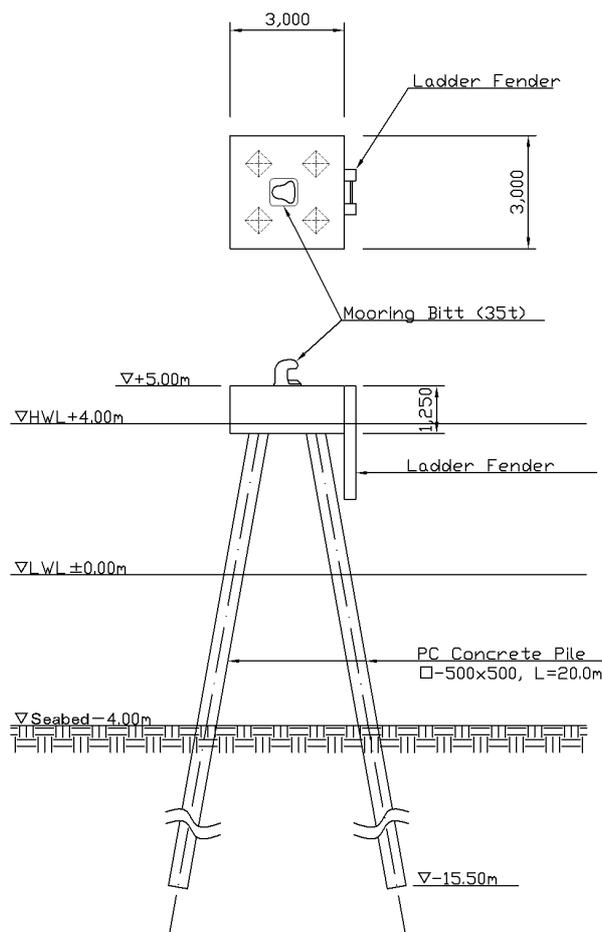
Plan típico y sección de Delfín de Amarre
